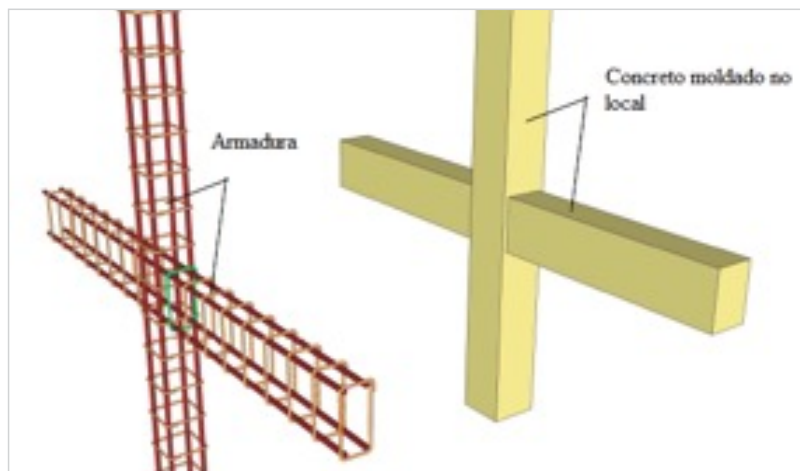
Ligação viga-pilar em concreto armado moldado no local
